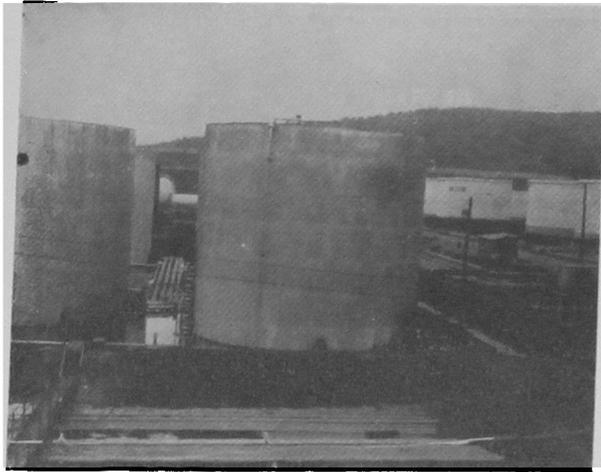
Fallas por corte en arenas saturadas, Refinería de Petróleo de Concón.
